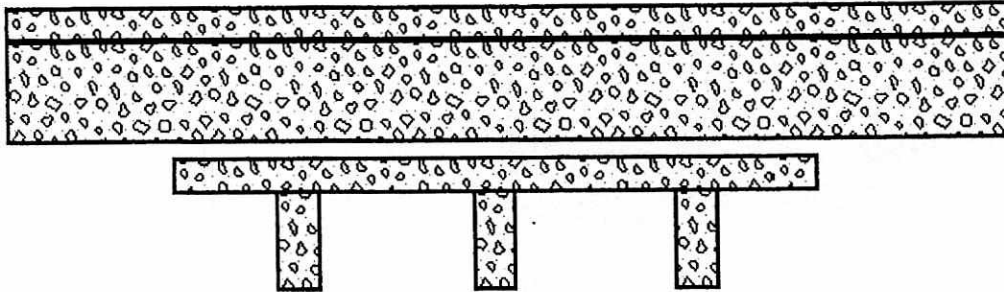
Puente con vigas longitudinales de concreto reforzado.
